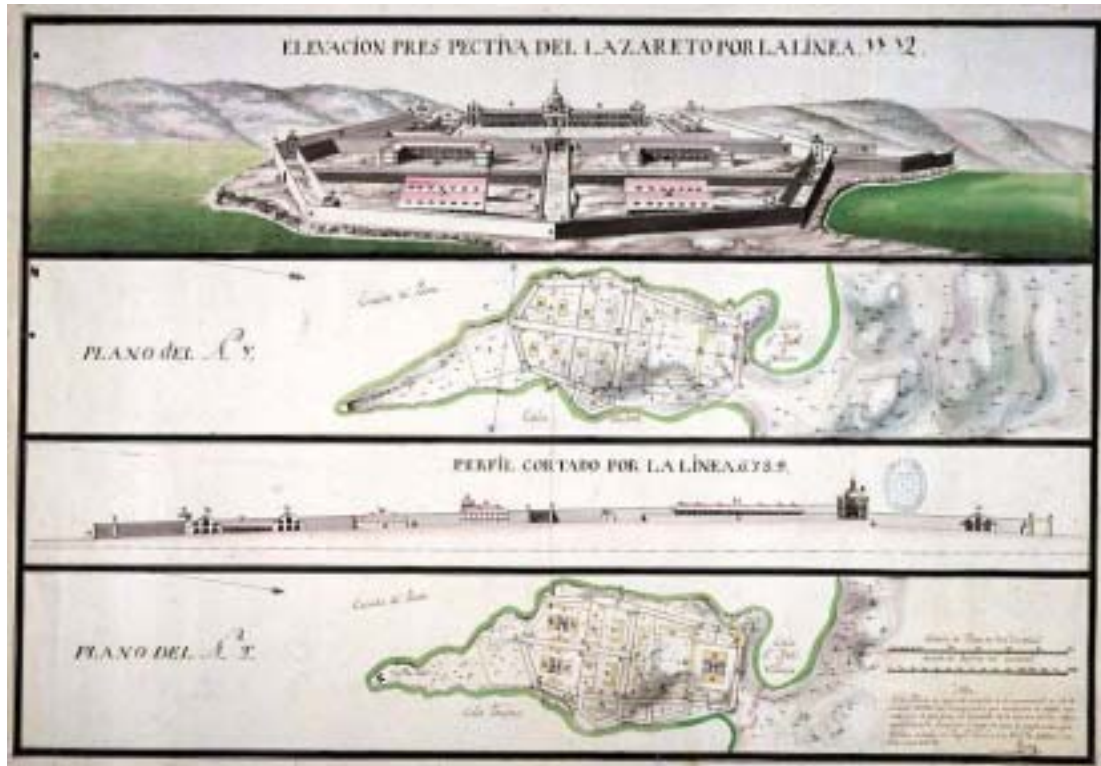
Lazareto de Mahón, perspectiva, planta y elevación (SHM, 3588-13)
